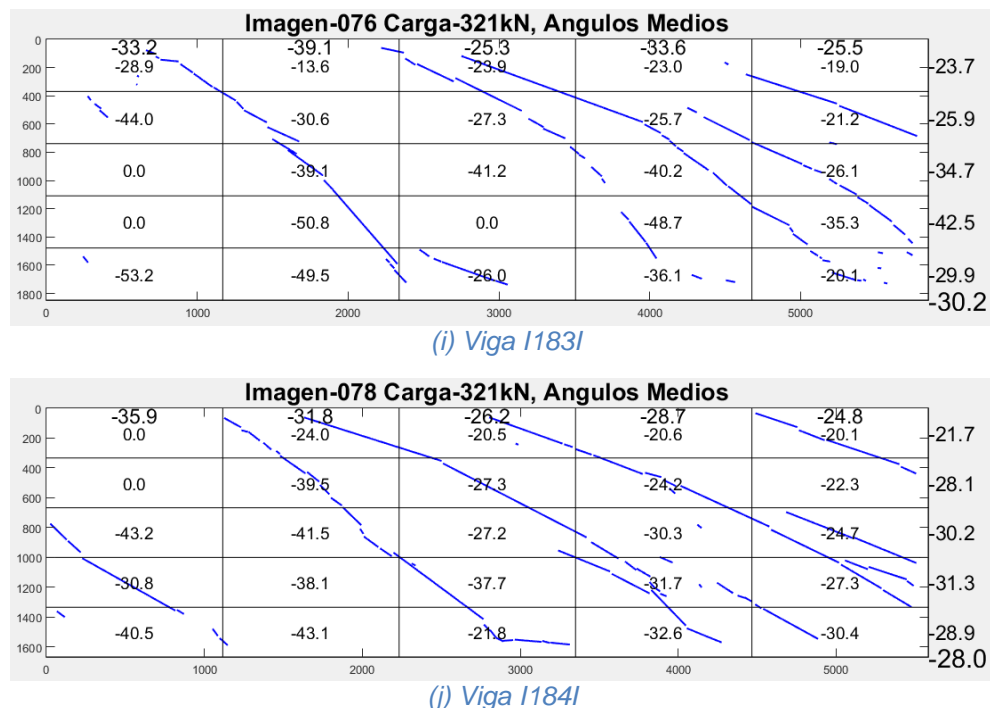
Patrón de fisuras en las Vigas.
